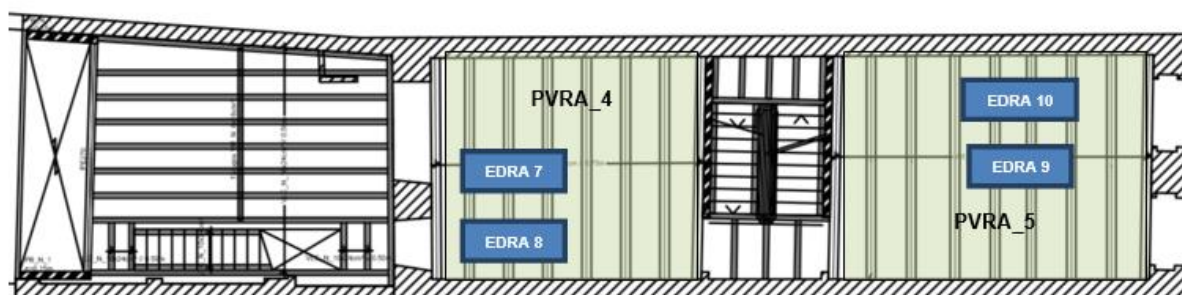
Planta do piso 2, com identificação esquemática dos pavimentos e ensaios dinâmicos
